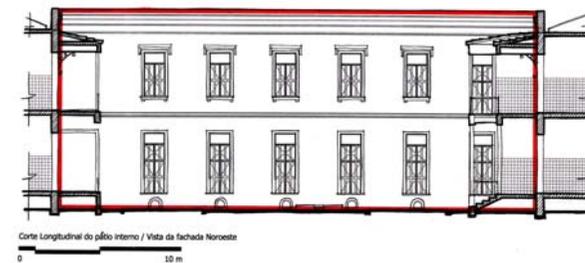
Estudo de proporção do pátio interno principal do CP11, corte longitudinal e vista da fachada Noroeste (Fonte: O AUTOR,2006).
